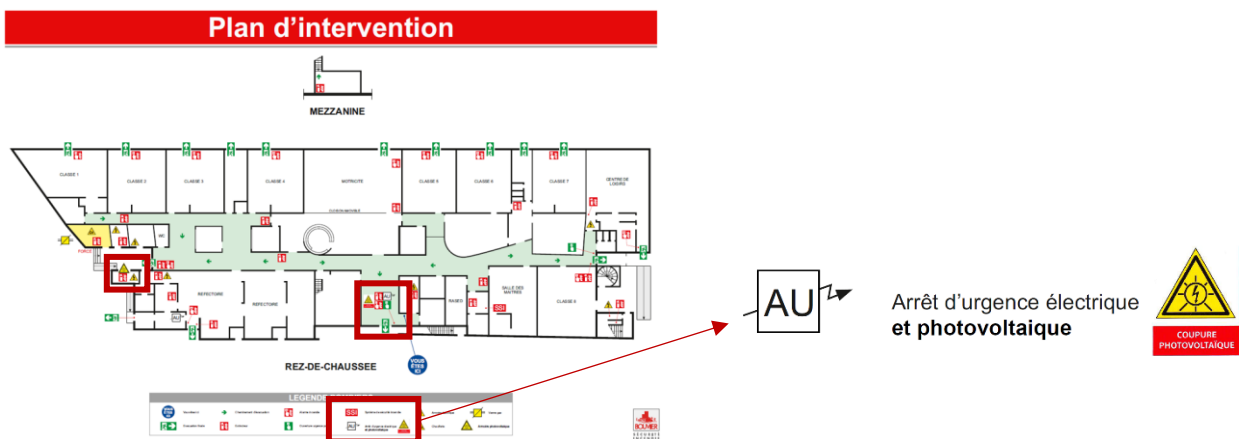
Exemple de modification de plan d'intervention par le lot photovoltaïque
